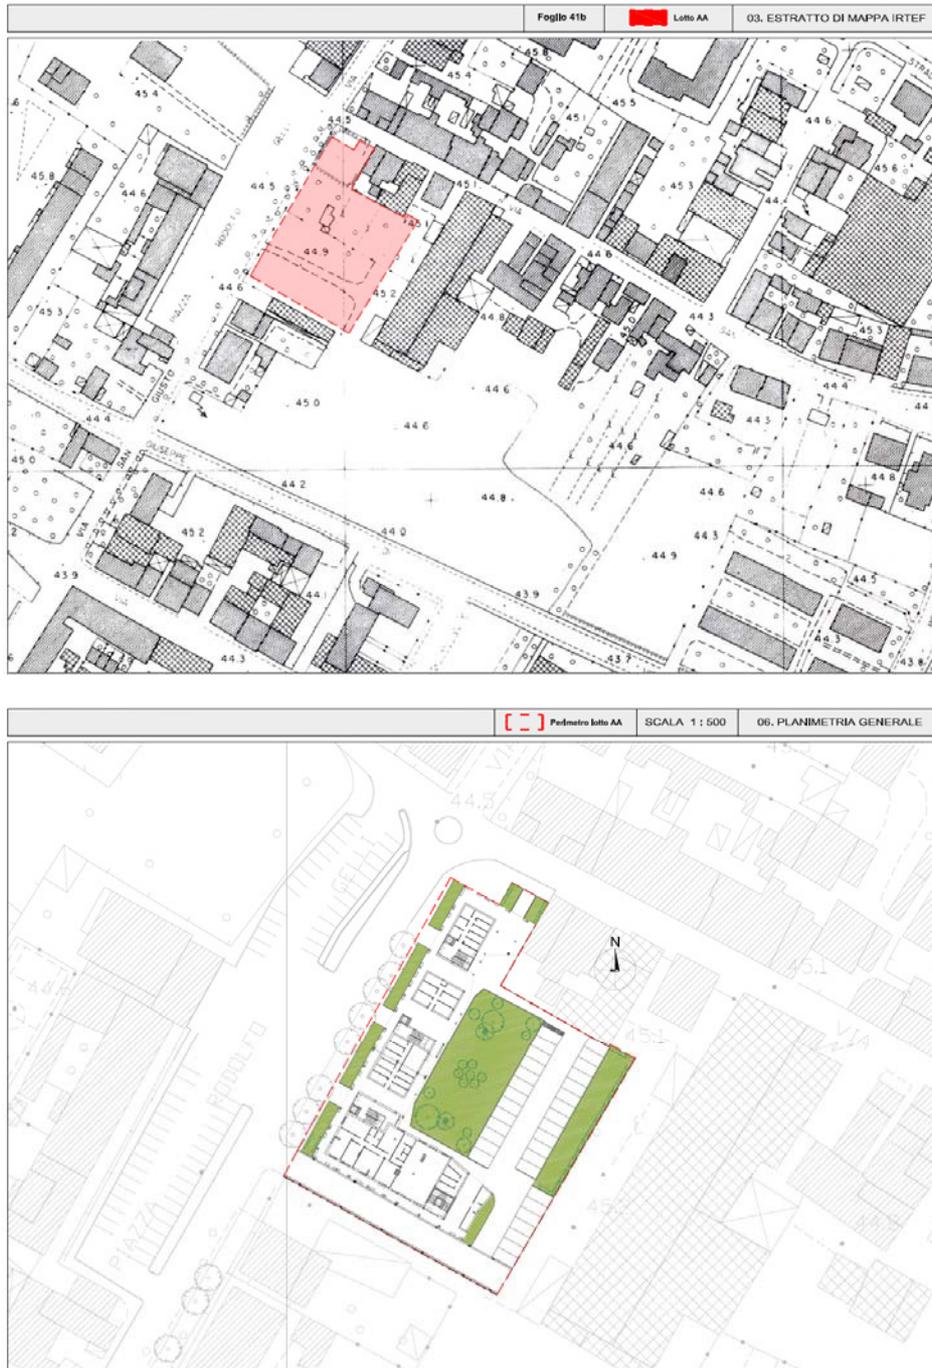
Planimetria con indicata in rosso l'area di intervento e dettaglio dell'edificio di progetto.
